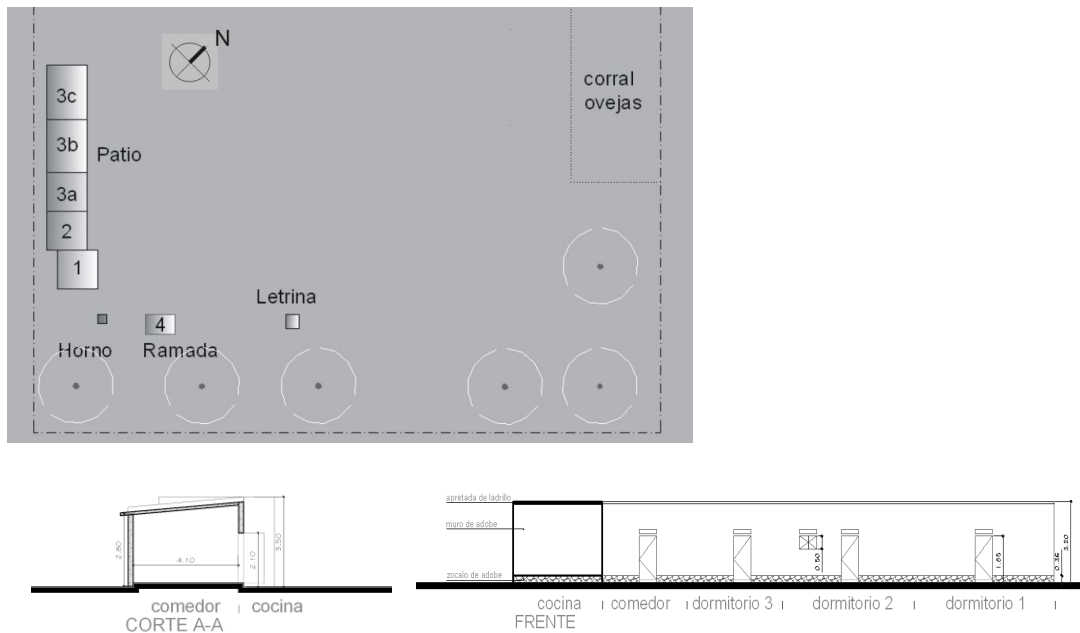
Planta de conjunto y corte transversal A-A y frente N-E.
